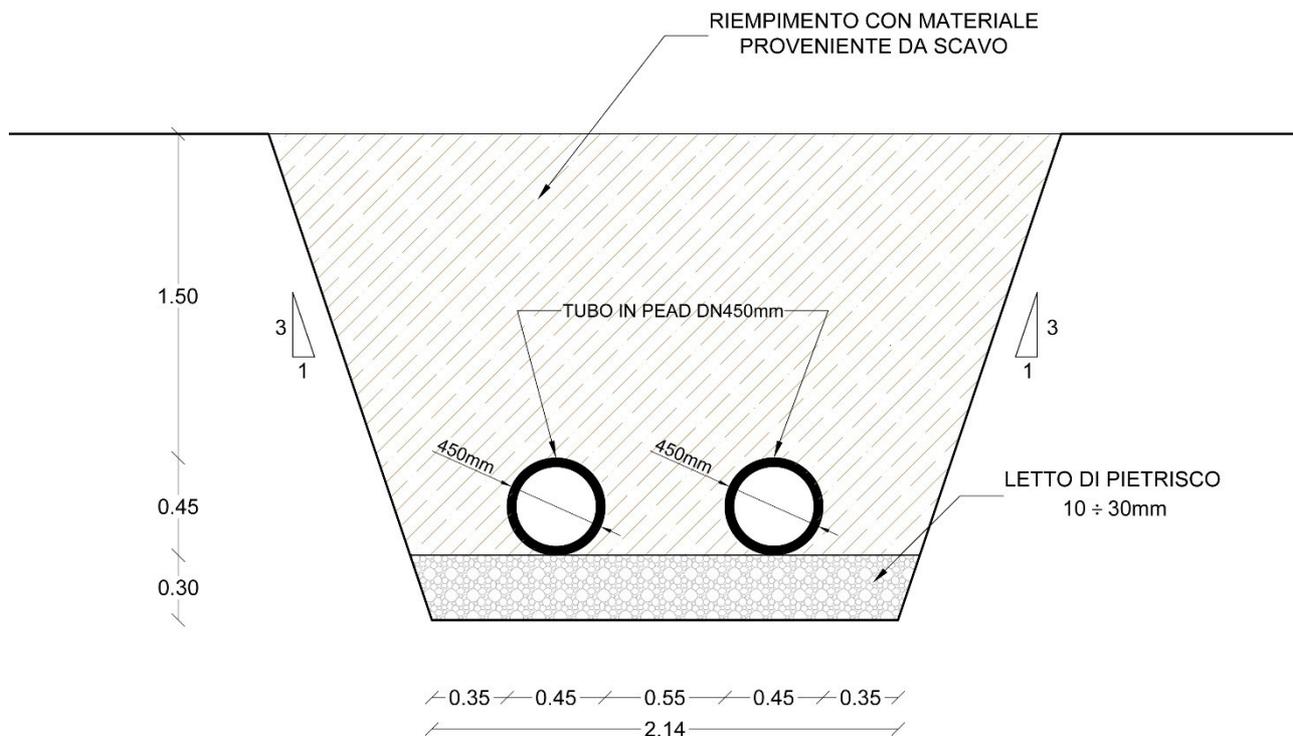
Sezione tipo di cavo di posa condotta di presa e scarico dalla prog. 0,00 m alla prog. 1880,74 m.
